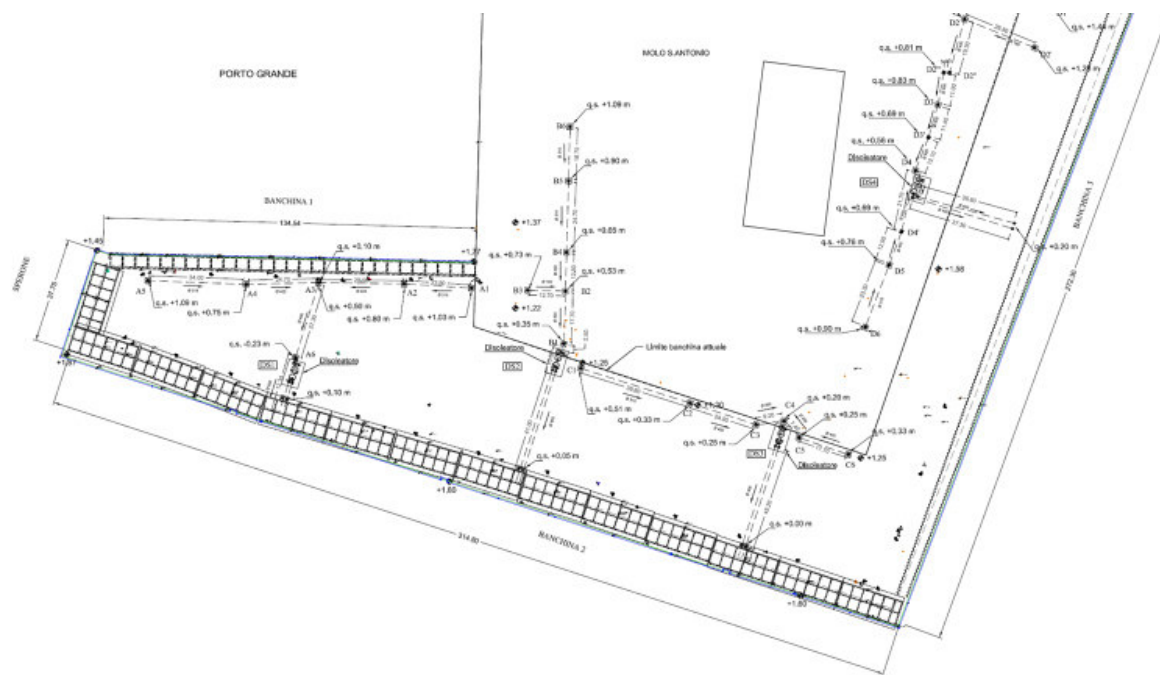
Stralcio planimetria EEG10016T2292 – Banchina 2 e 3
